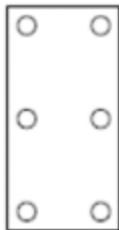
Plans de chevillage – panneaux de dimensions 1000 × 500 mm
